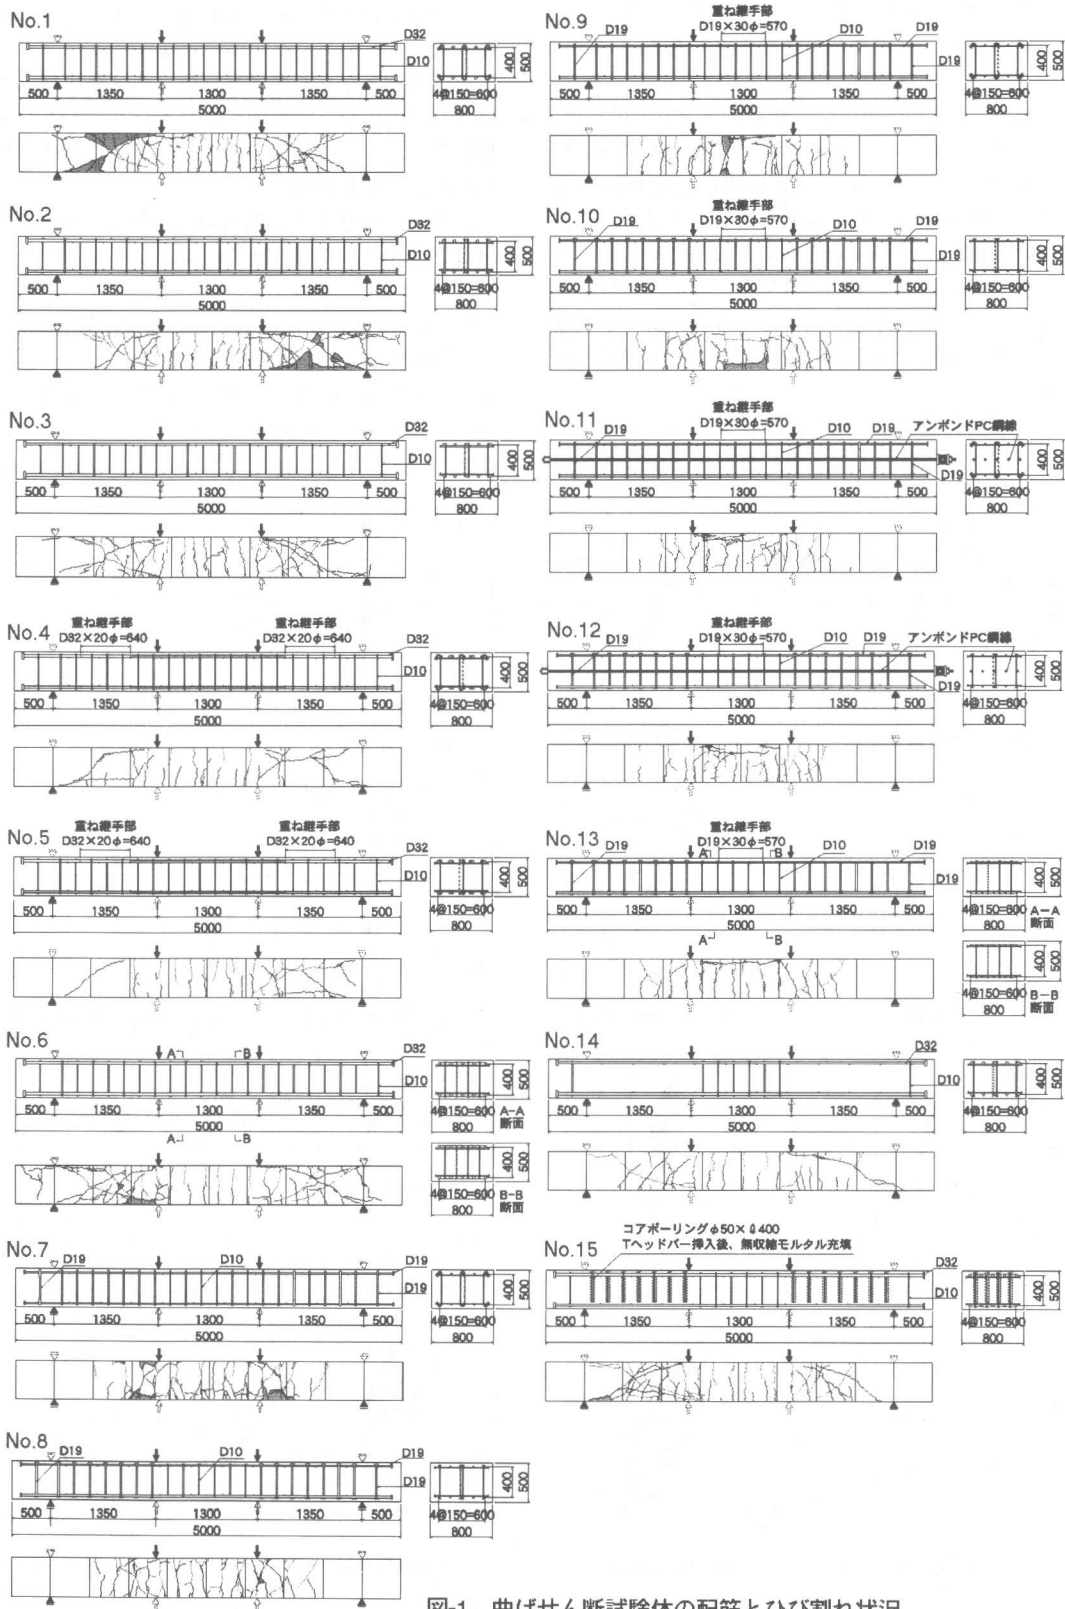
曲げせん断試験体の配筋とひび割れ状況
